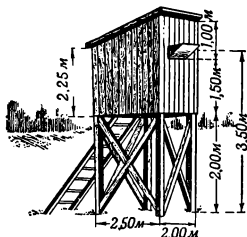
Внешний вид высокой будки круглого стенда и ее основные размеры
